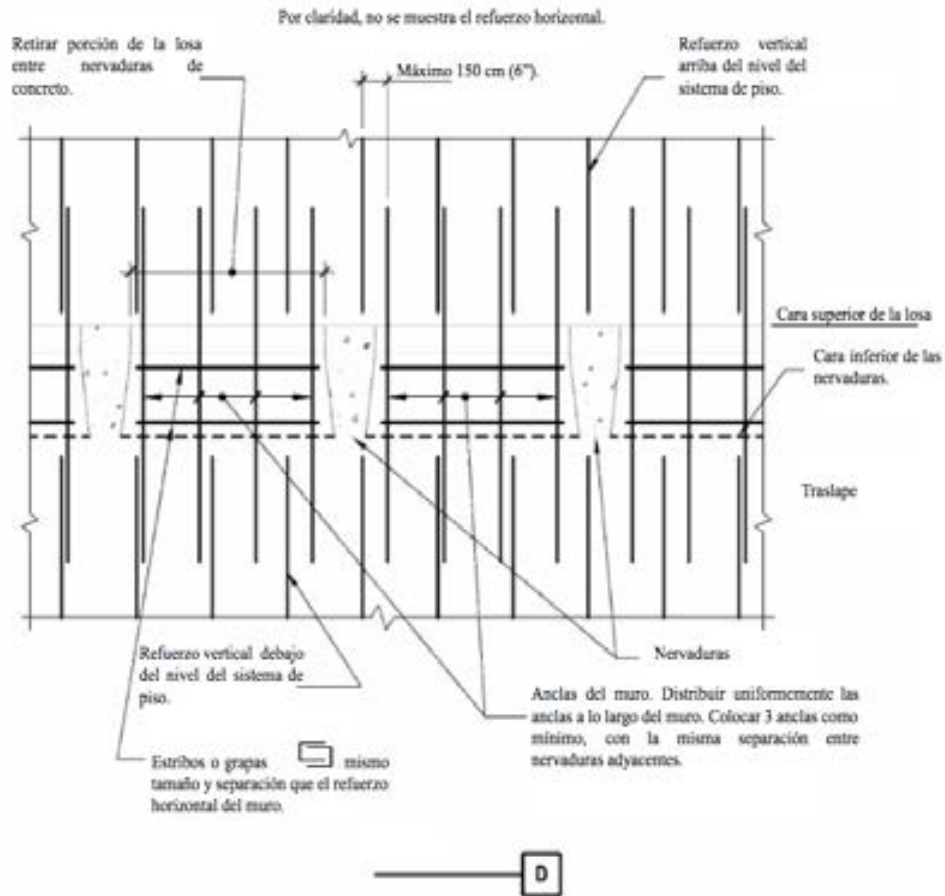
Conexión de un muro en edificios con losas reticulares o con losas nervadas en la dirección perpendicular al muro (FEMA 547)
